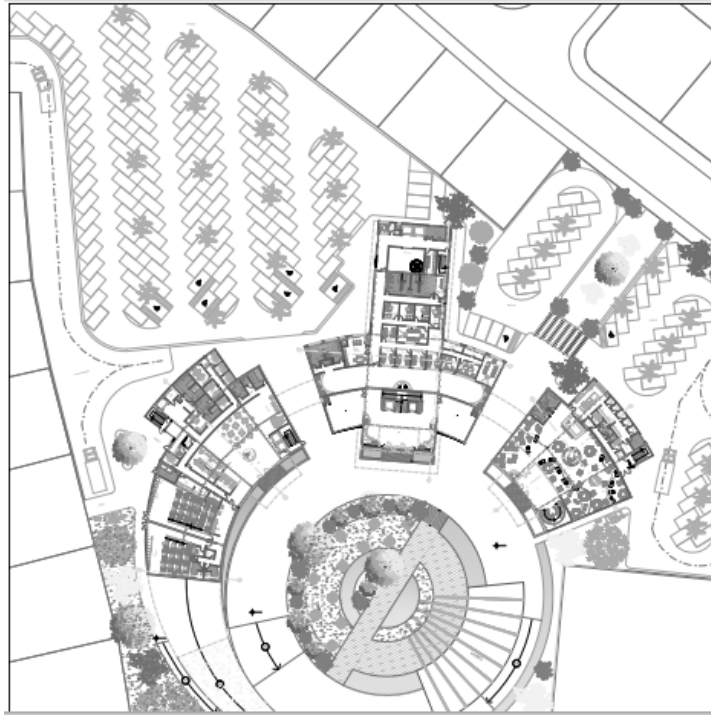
Planta Baja. Nivel de Acceso +1.15 (2020)
